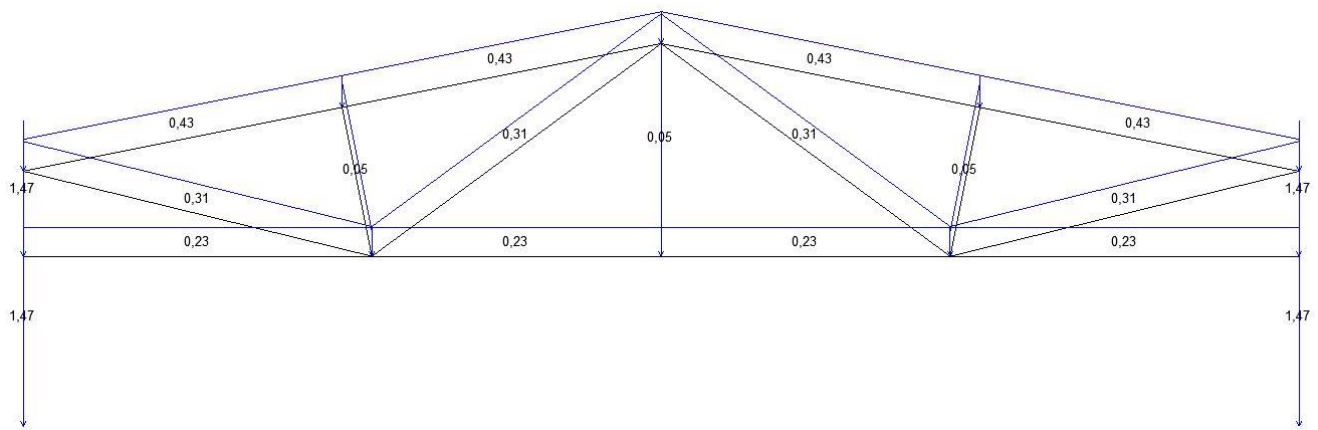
Нагрузка на ферму и колонну от собственного веса конструкций
